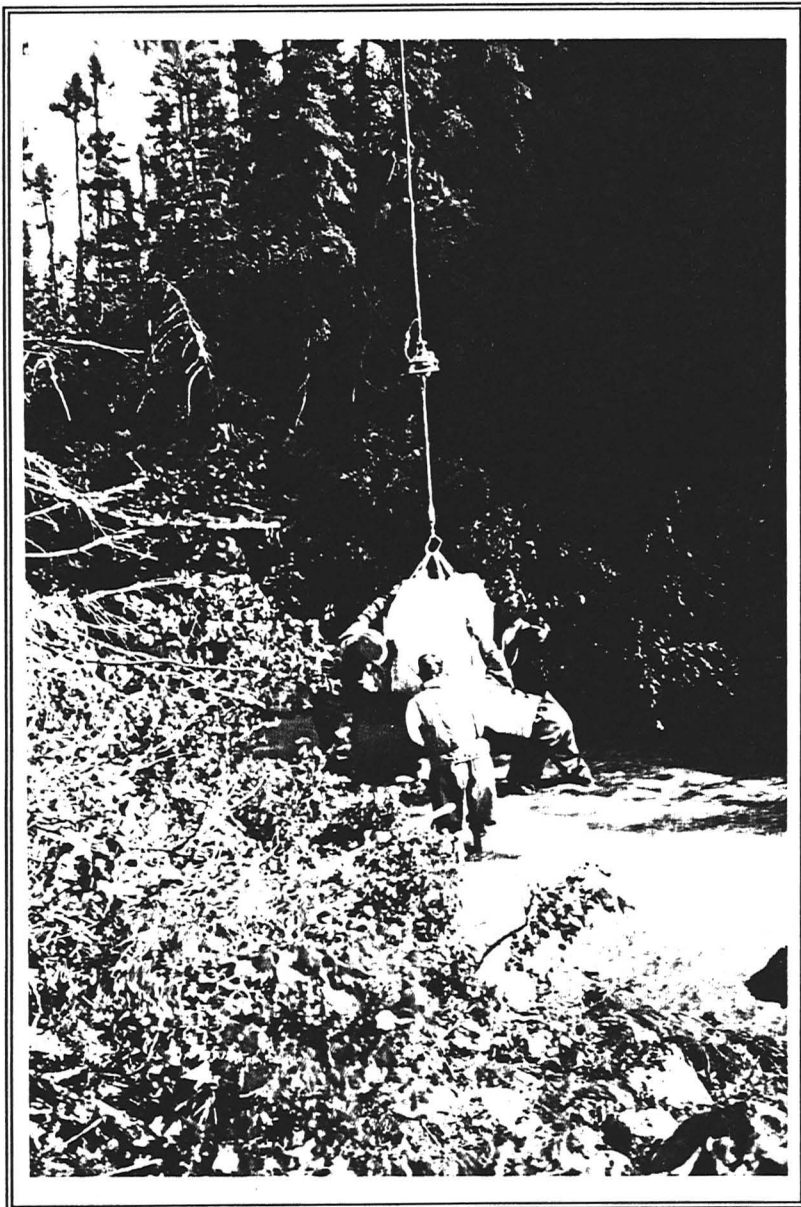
Language et mise en place du gravier sur les bassins préalablement aménagés.
